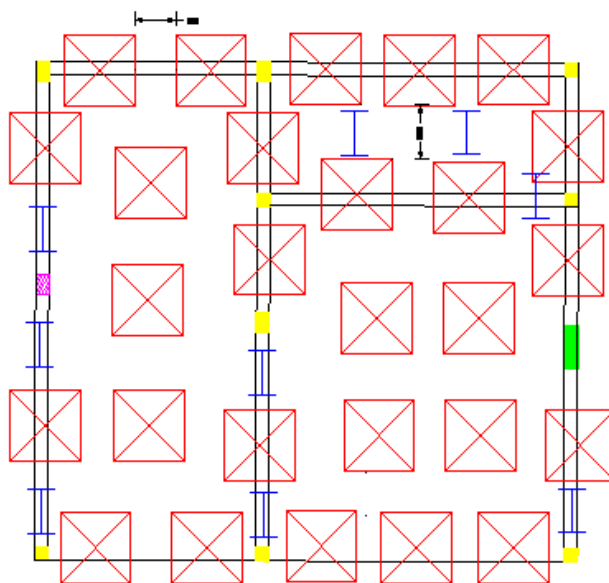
PLAN DE CALEPINAGE D'ETAIS POUR LA VARIANTE EN DALLE PLEINE
